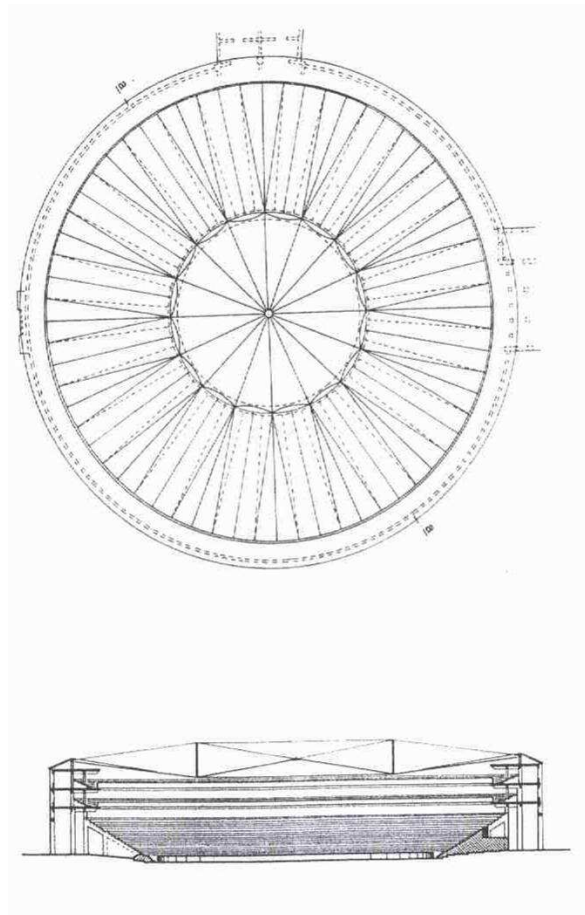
Grundriss und Schnitt; aus /8/
